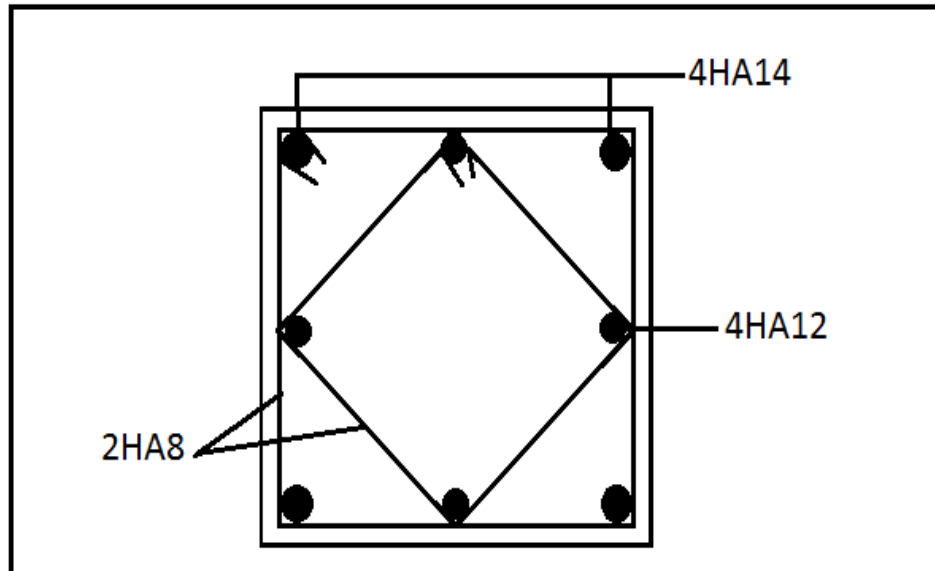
Ferrailage Poteau 35x35
